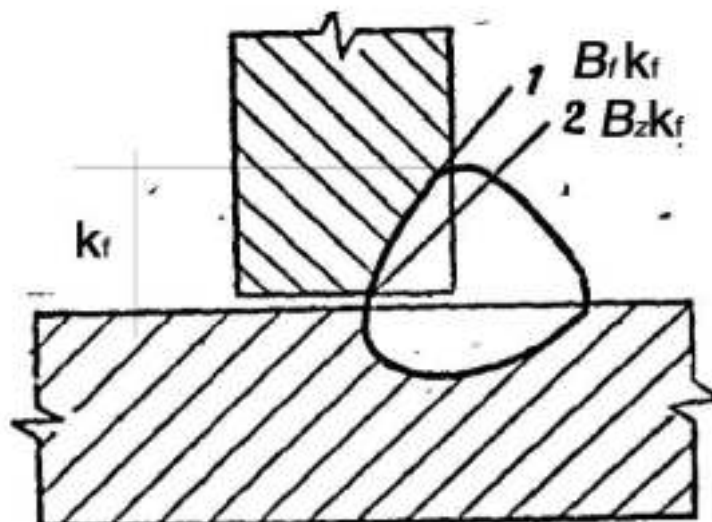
Схема расчётных сечений сварных соединений с угловыми швами
